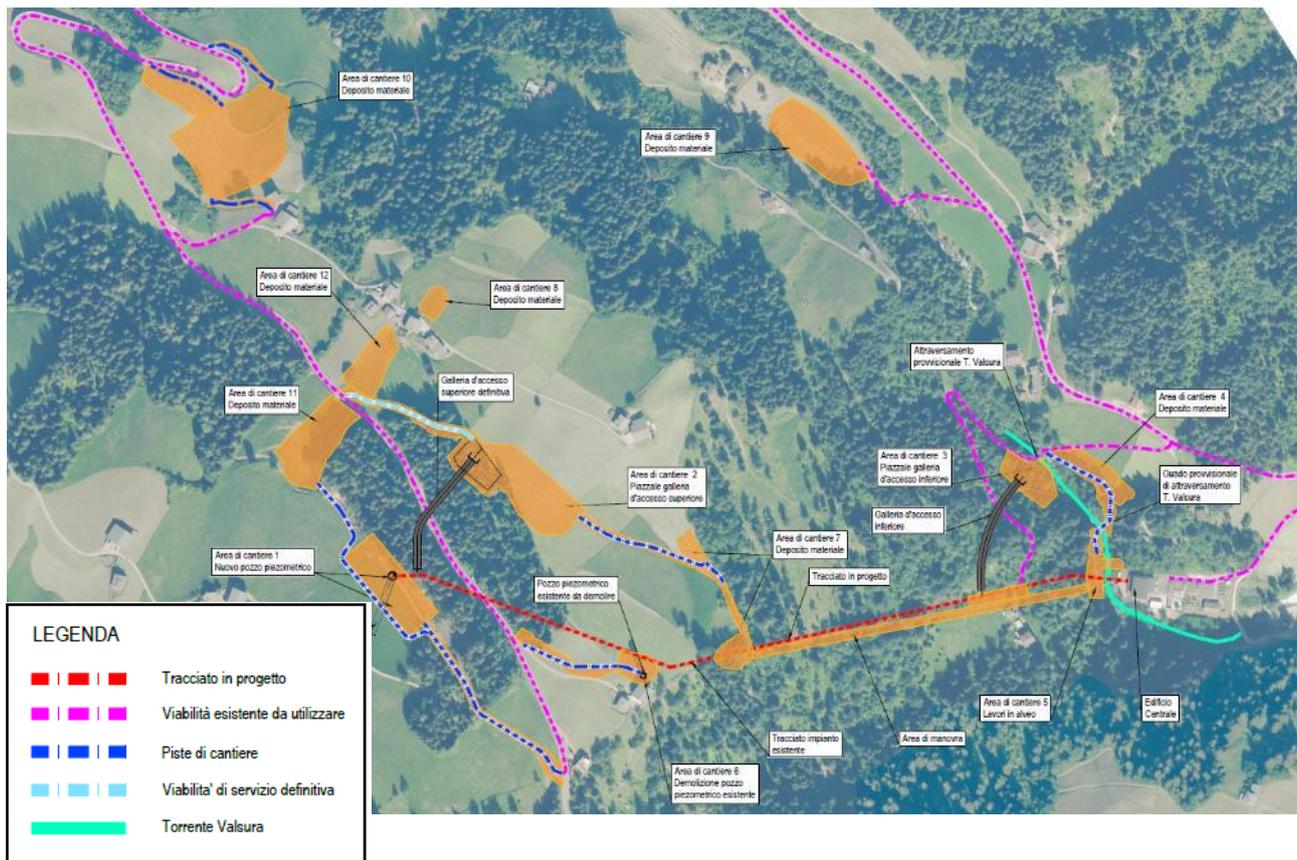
Planimetria con localizzazione delle aree di cantiere - stralcio dell'elaborato H.3 "Layout delle aree e delle piste di cantiere".
